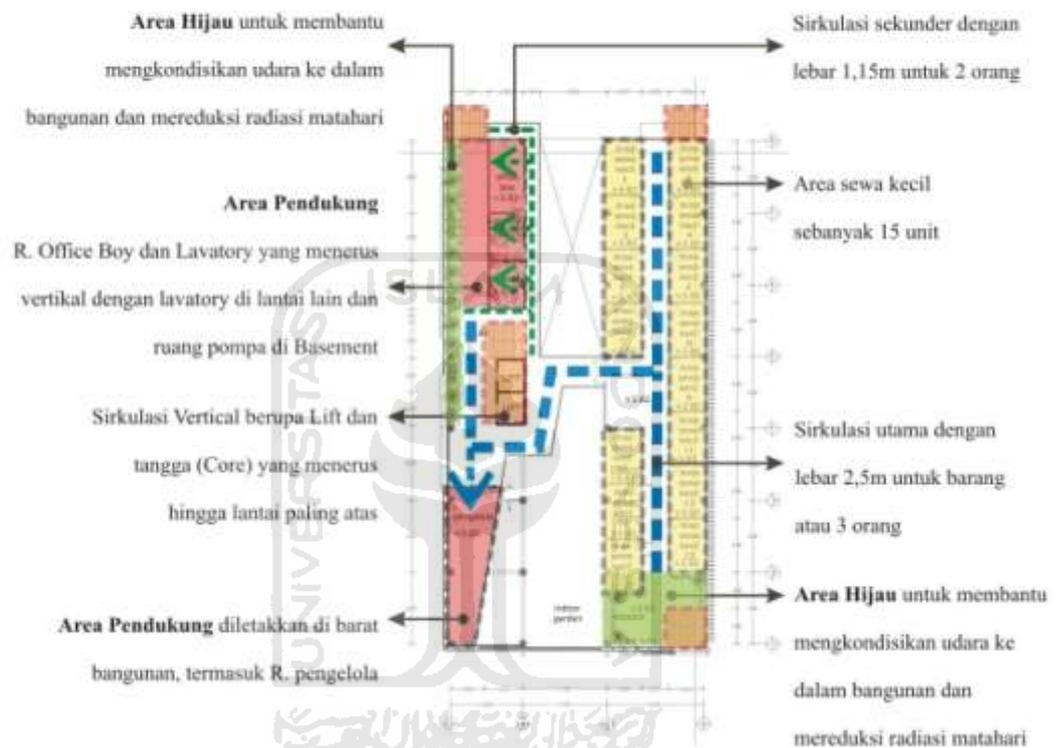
Konsep Zonase Ruang Ground Floor
